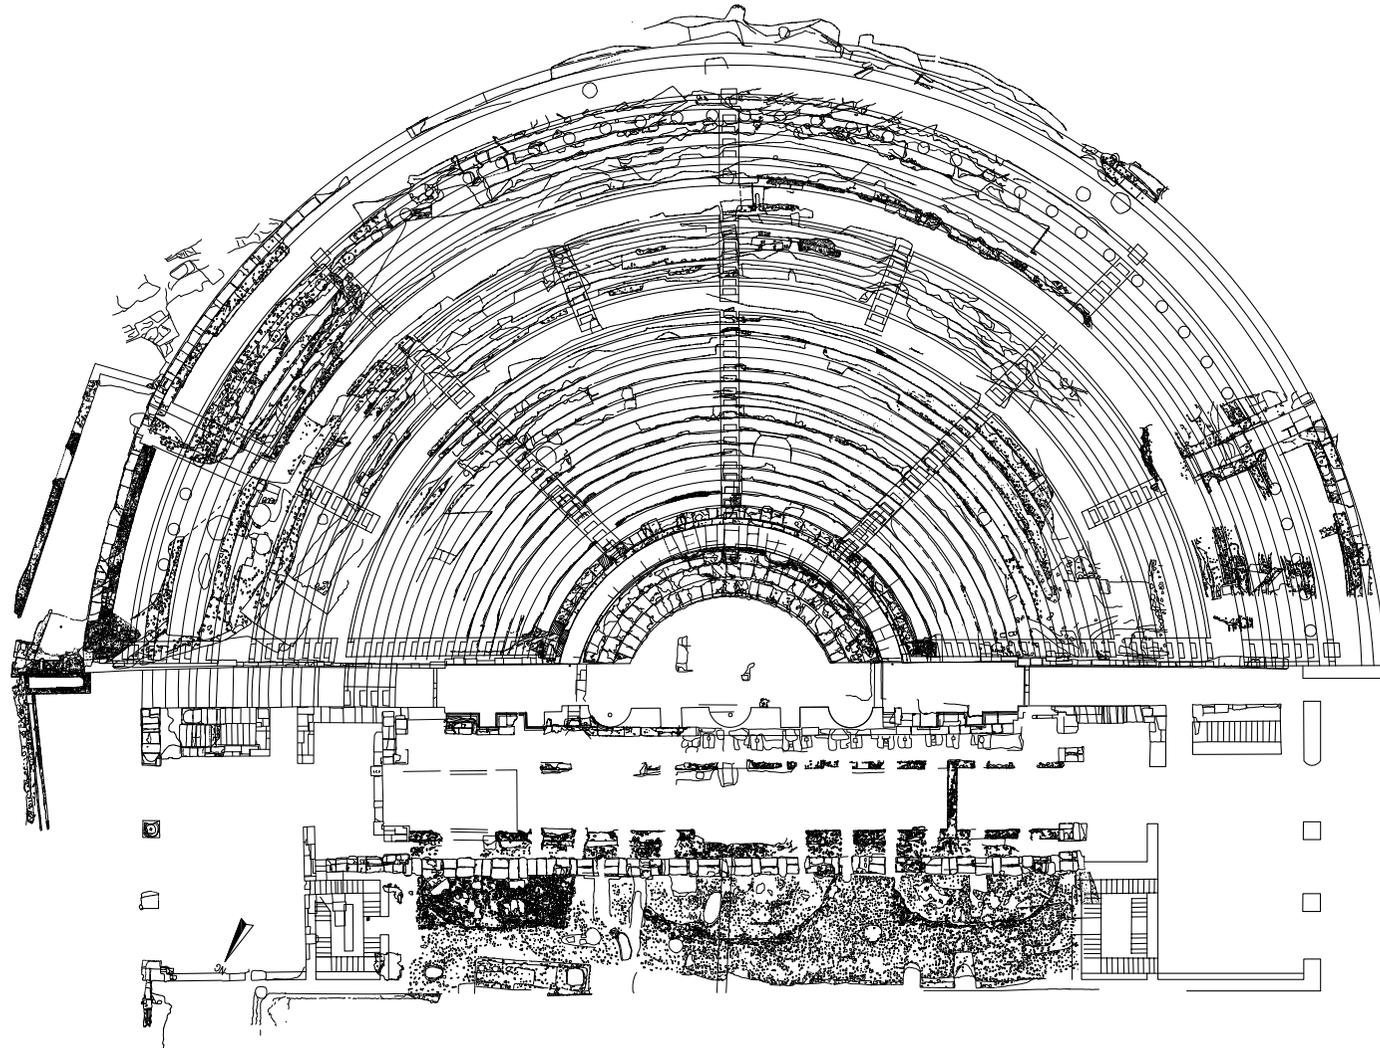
Planta de la intervención en la cavea sobre la planta original del teatro.
